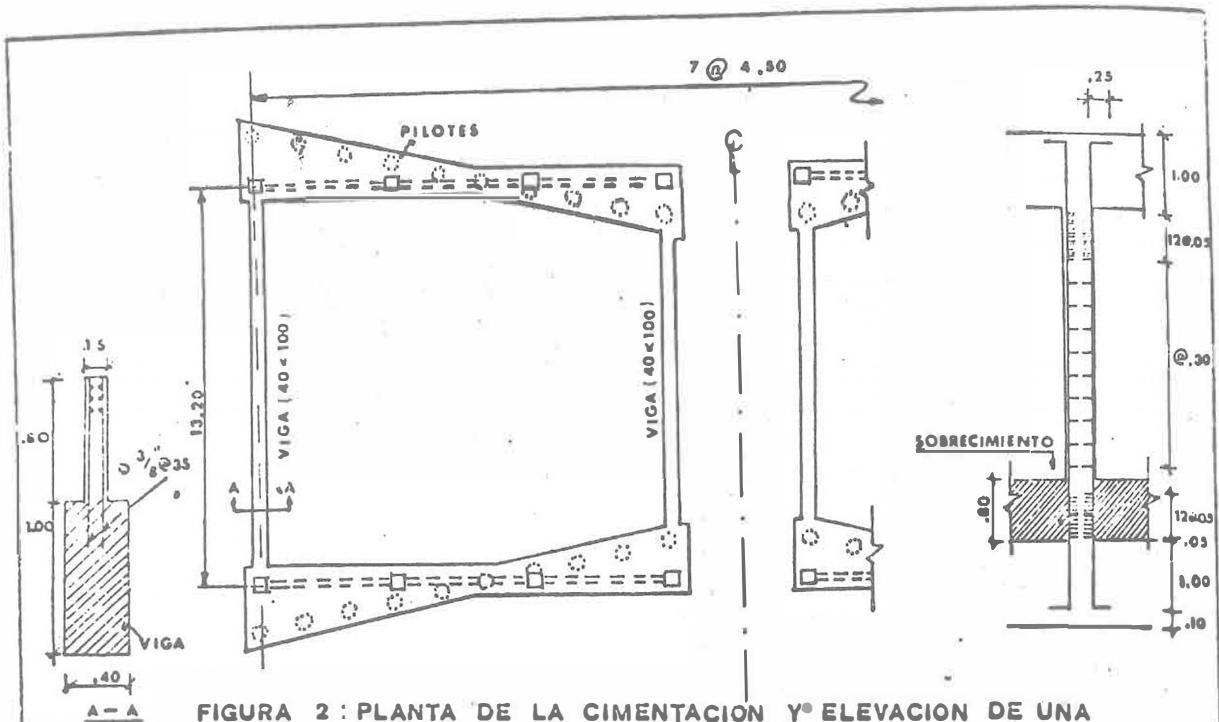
PLANTA DE LA CIMENTACION Y° ELEVACION DE UNA COLUMNA TIPICA INDICANDO ESTRIBOS
